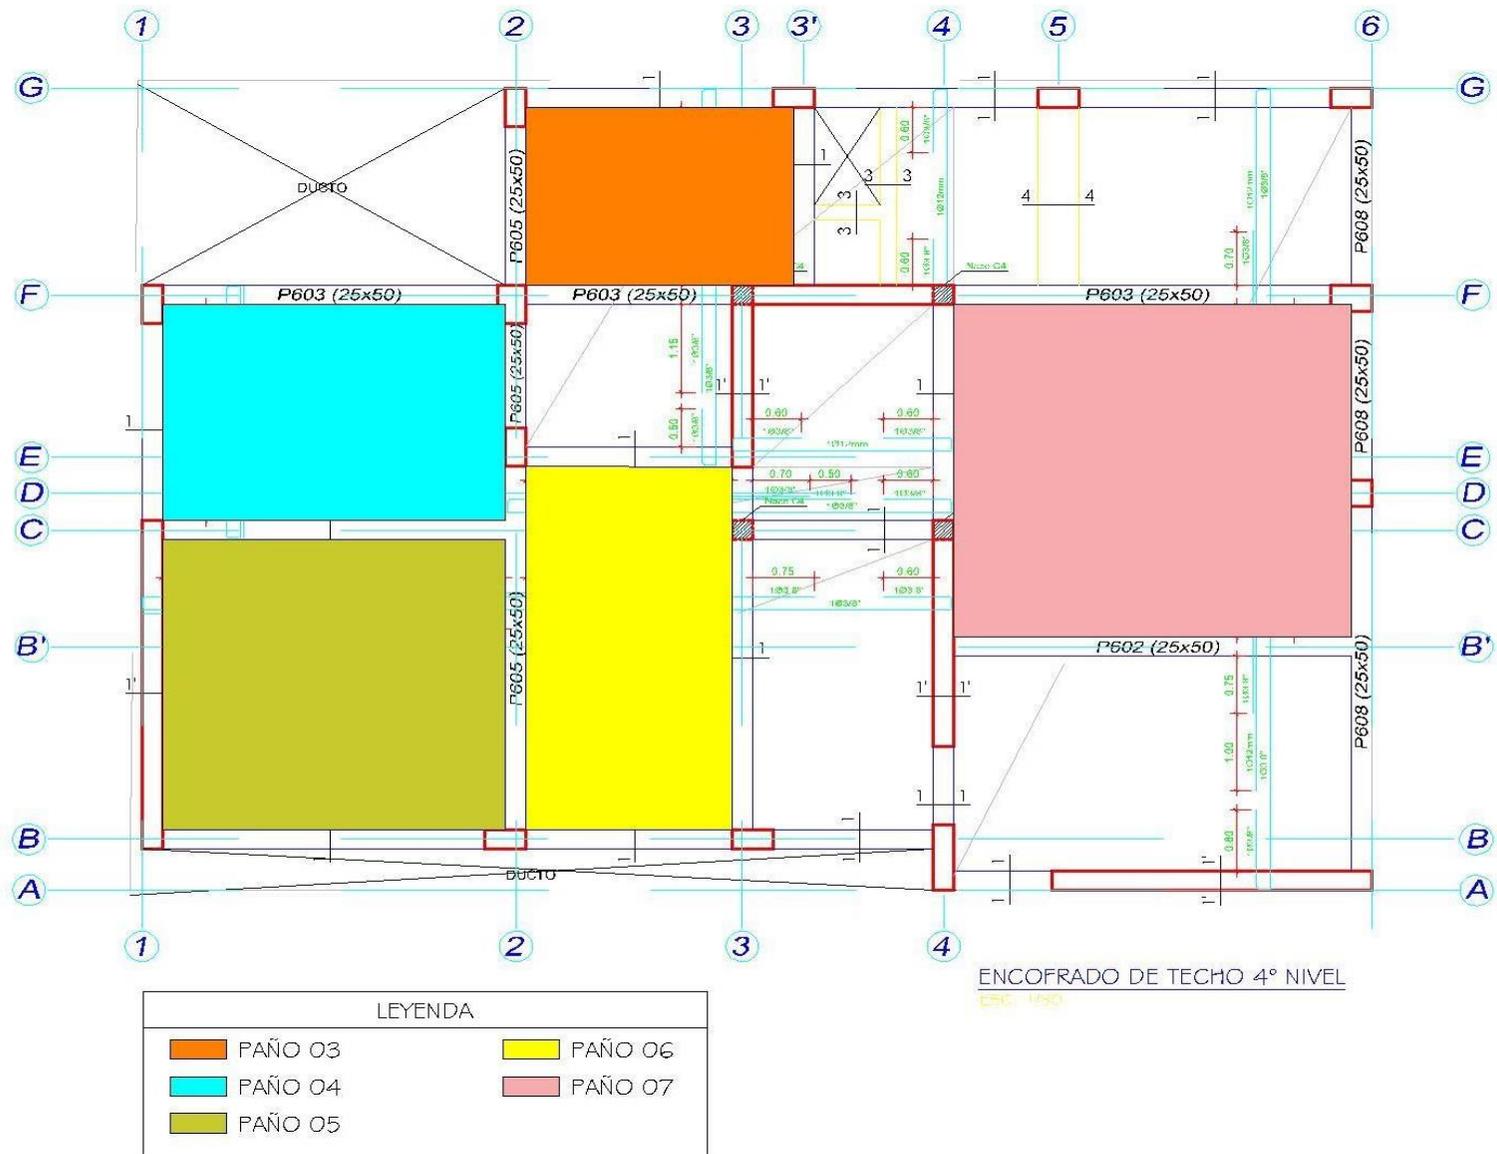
Plano de encofrado tradicional de techo 4º Nivel de la obra "Residencial Home Green".
